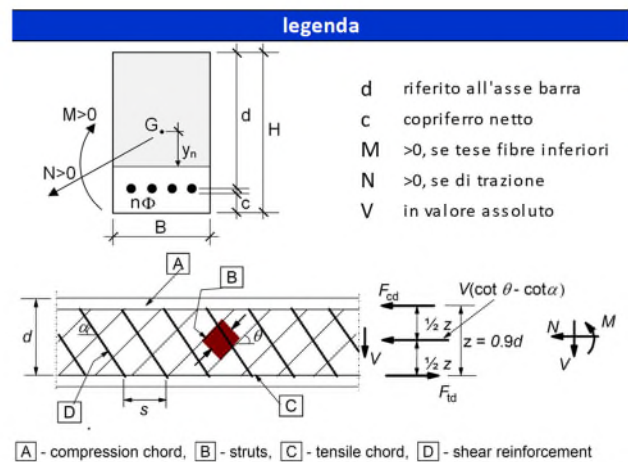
Verifica strutturale SLU - Sezione 4
